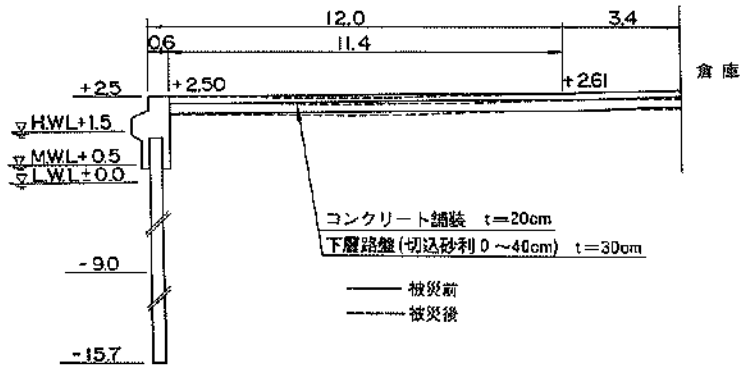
被災状況図 (中央埠頭地区, ⑦岸壁(-9.0m))
